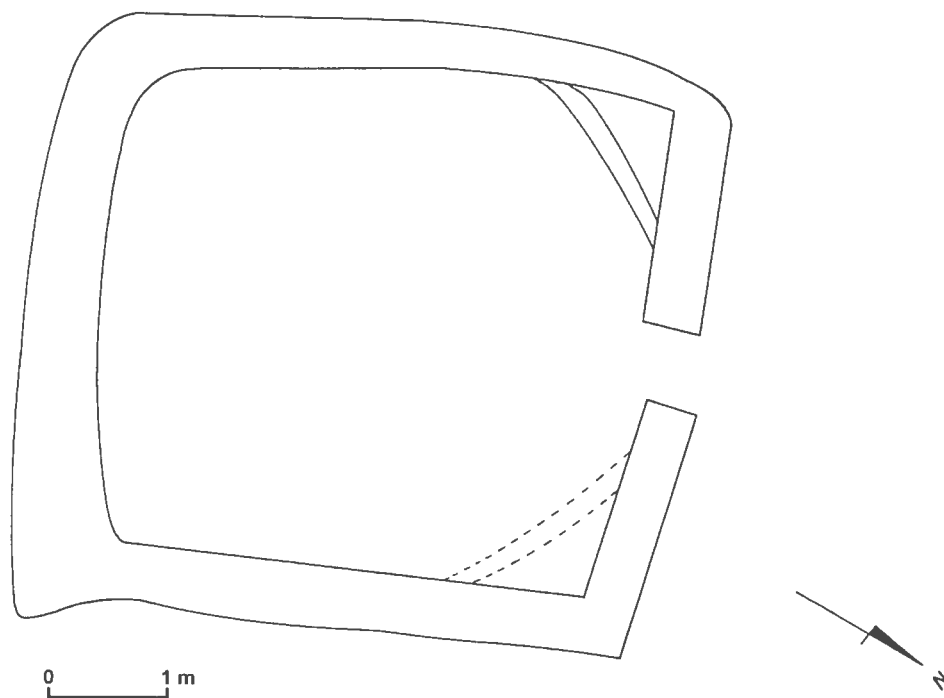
Plan de la même habitation à plan simple que la Figure 65, site # 47 (Yuying) de Yanas.
